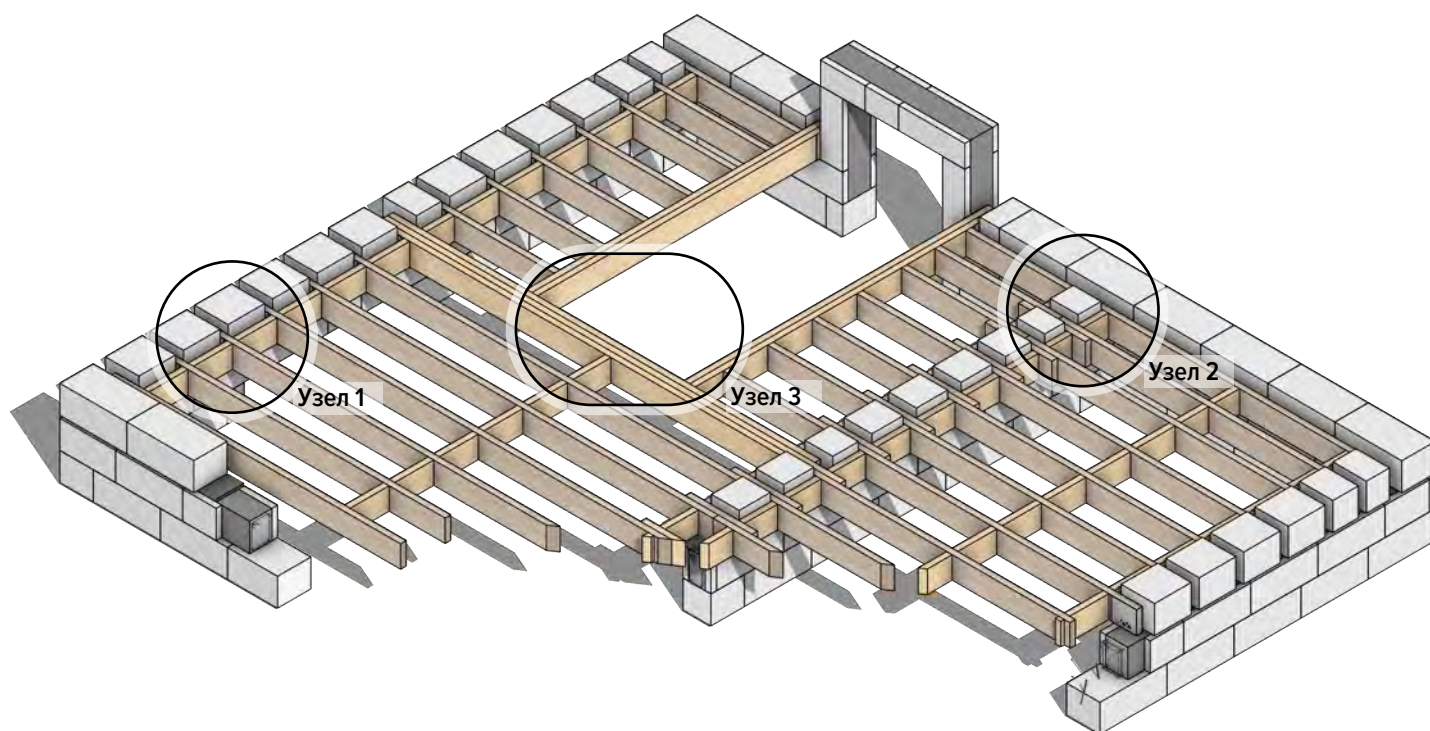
Конструкции деревянного межэтажного перекрытия
